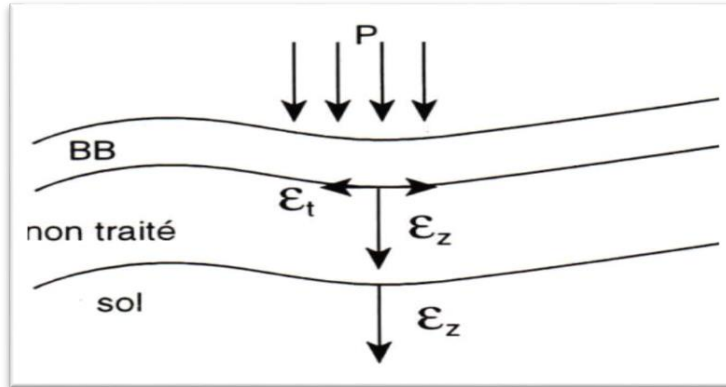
schémas de fonctionnement d'une structure de chaussée.
